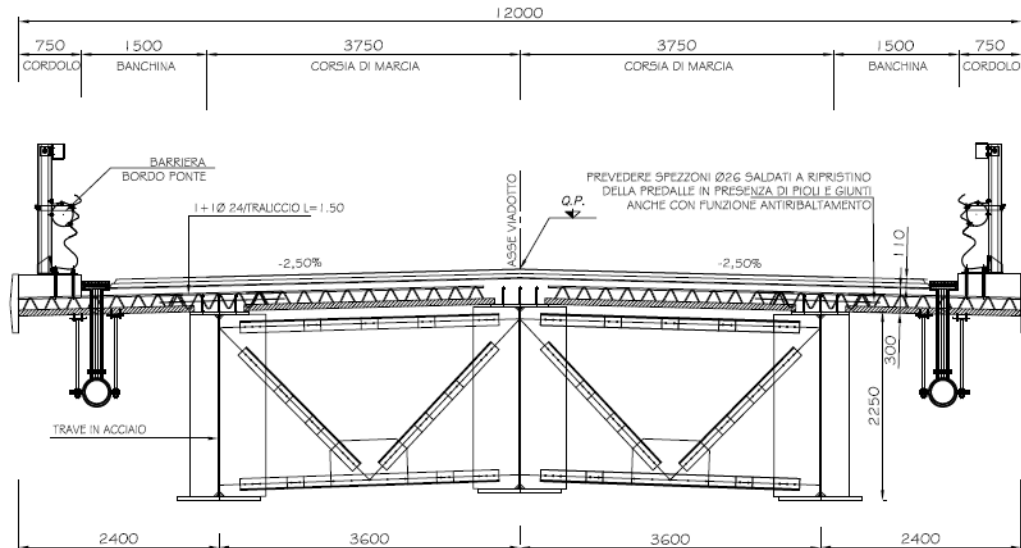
Sezione trasversale dell'impalcato – Sezione corrente trave H=2.25m
